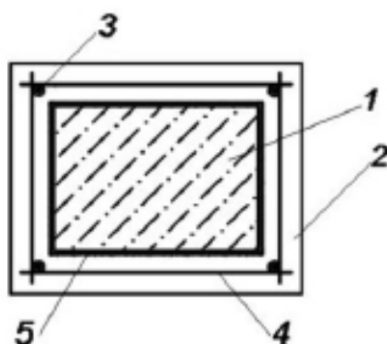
Железобетонная обойма с продольной и поперечной арматурой в виде замкнутых хомутов и слой адгезионной обмазки из жидкого стекла:
